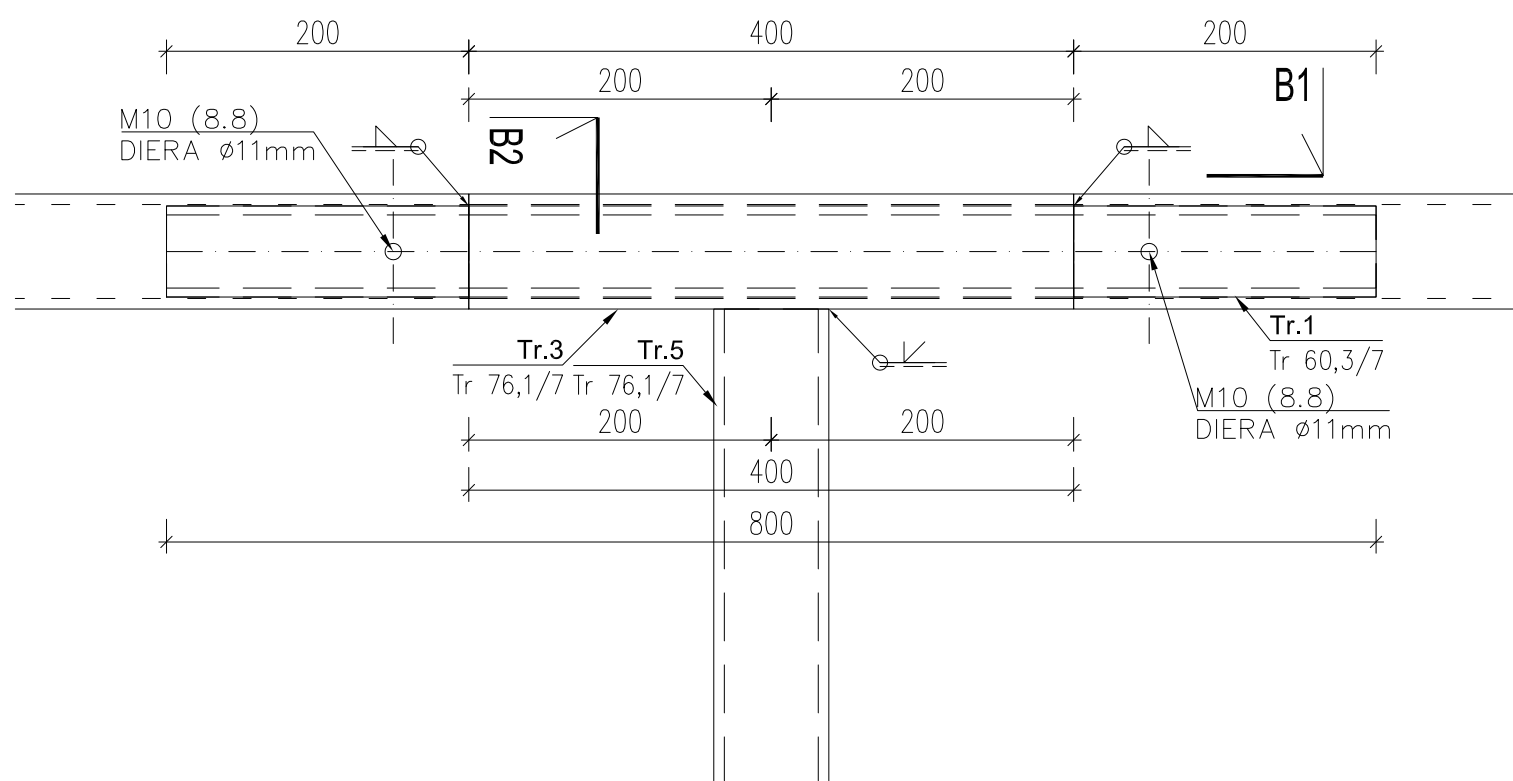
DETAIL "A" - REZOPOHĽAD A3; M 1:10
